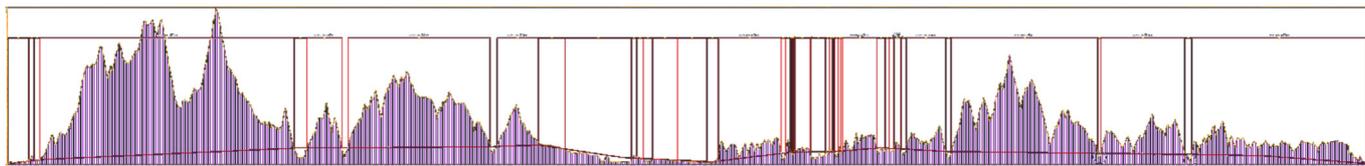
Profilo altimetrico Corridoio Tirrenico -tratta Sapri-Paola
